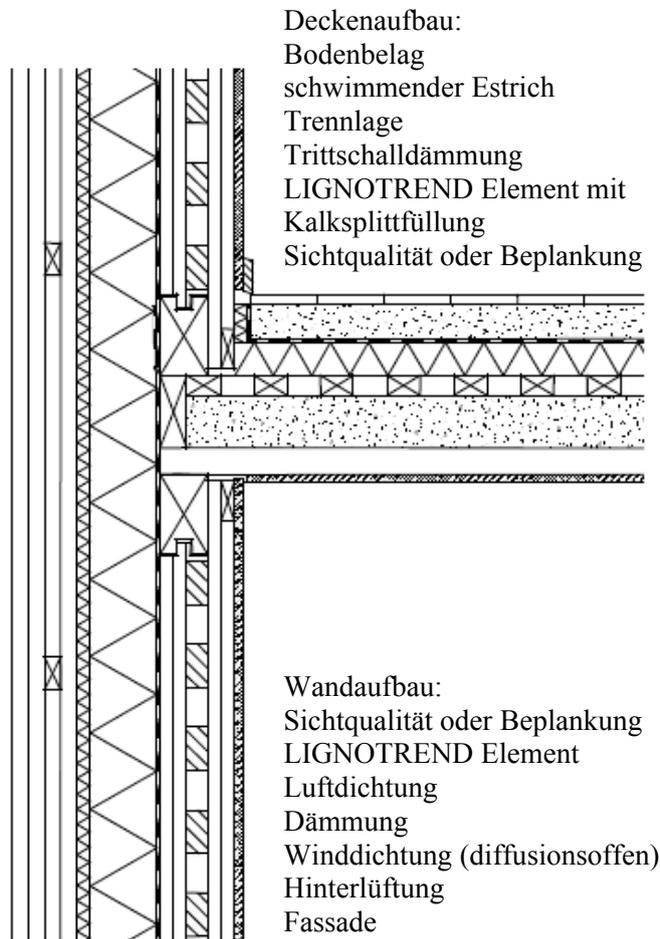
LIGNOTREND-Deckenaufbau [1]
